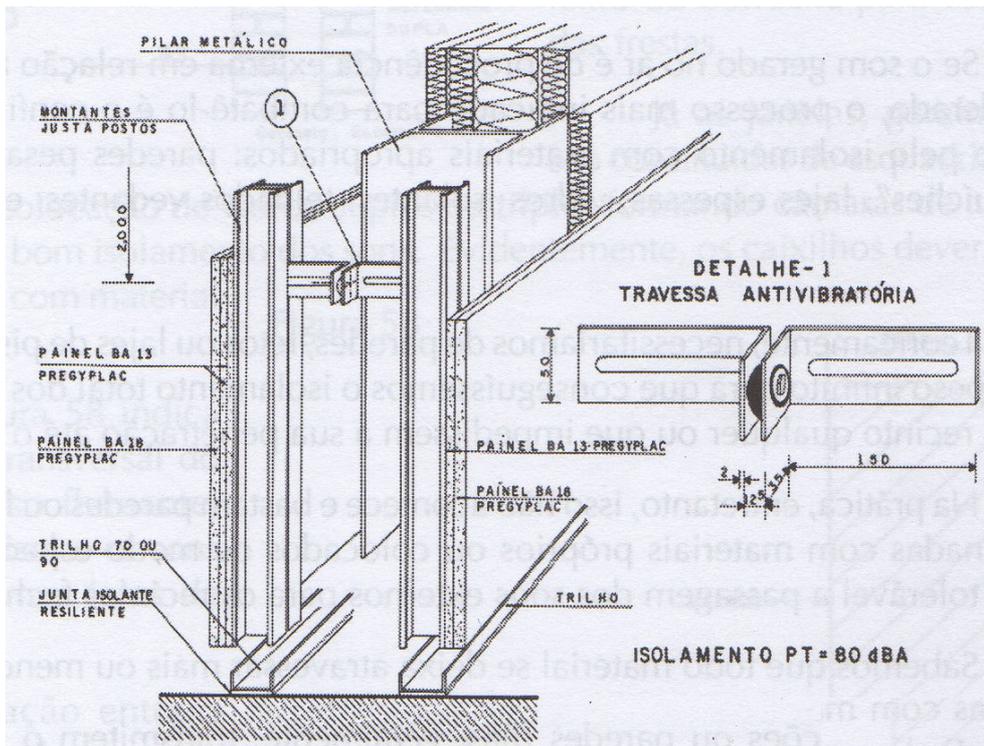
Estrutura Metálica com dois painéis de um lado e três painéis do outro e mais o sistema de travessa antivibratória.
